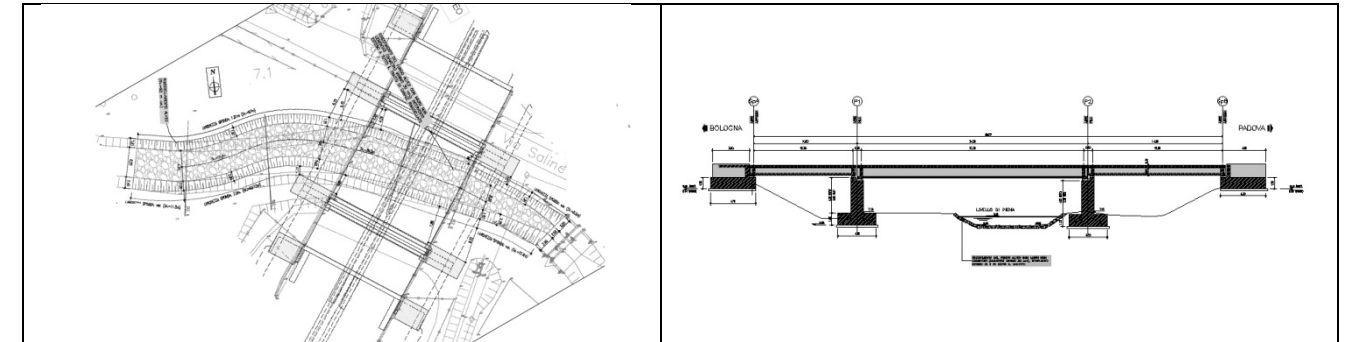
Canale Biancolino planimetria e sezione longitudinale
